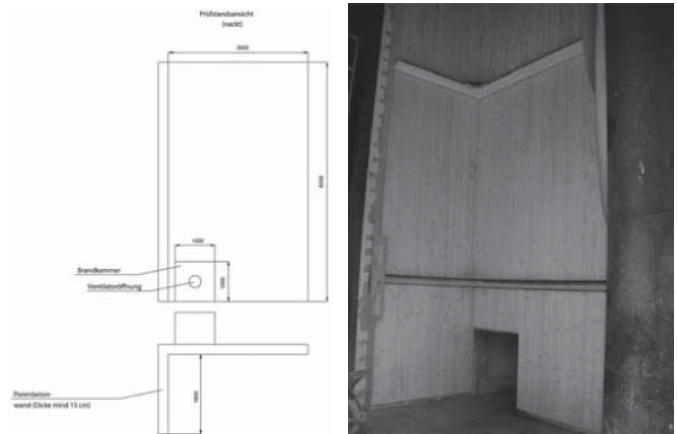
Zeichnung eines Prüfstandes nach ÖNORM 3800-5 mit montierter Fassade
